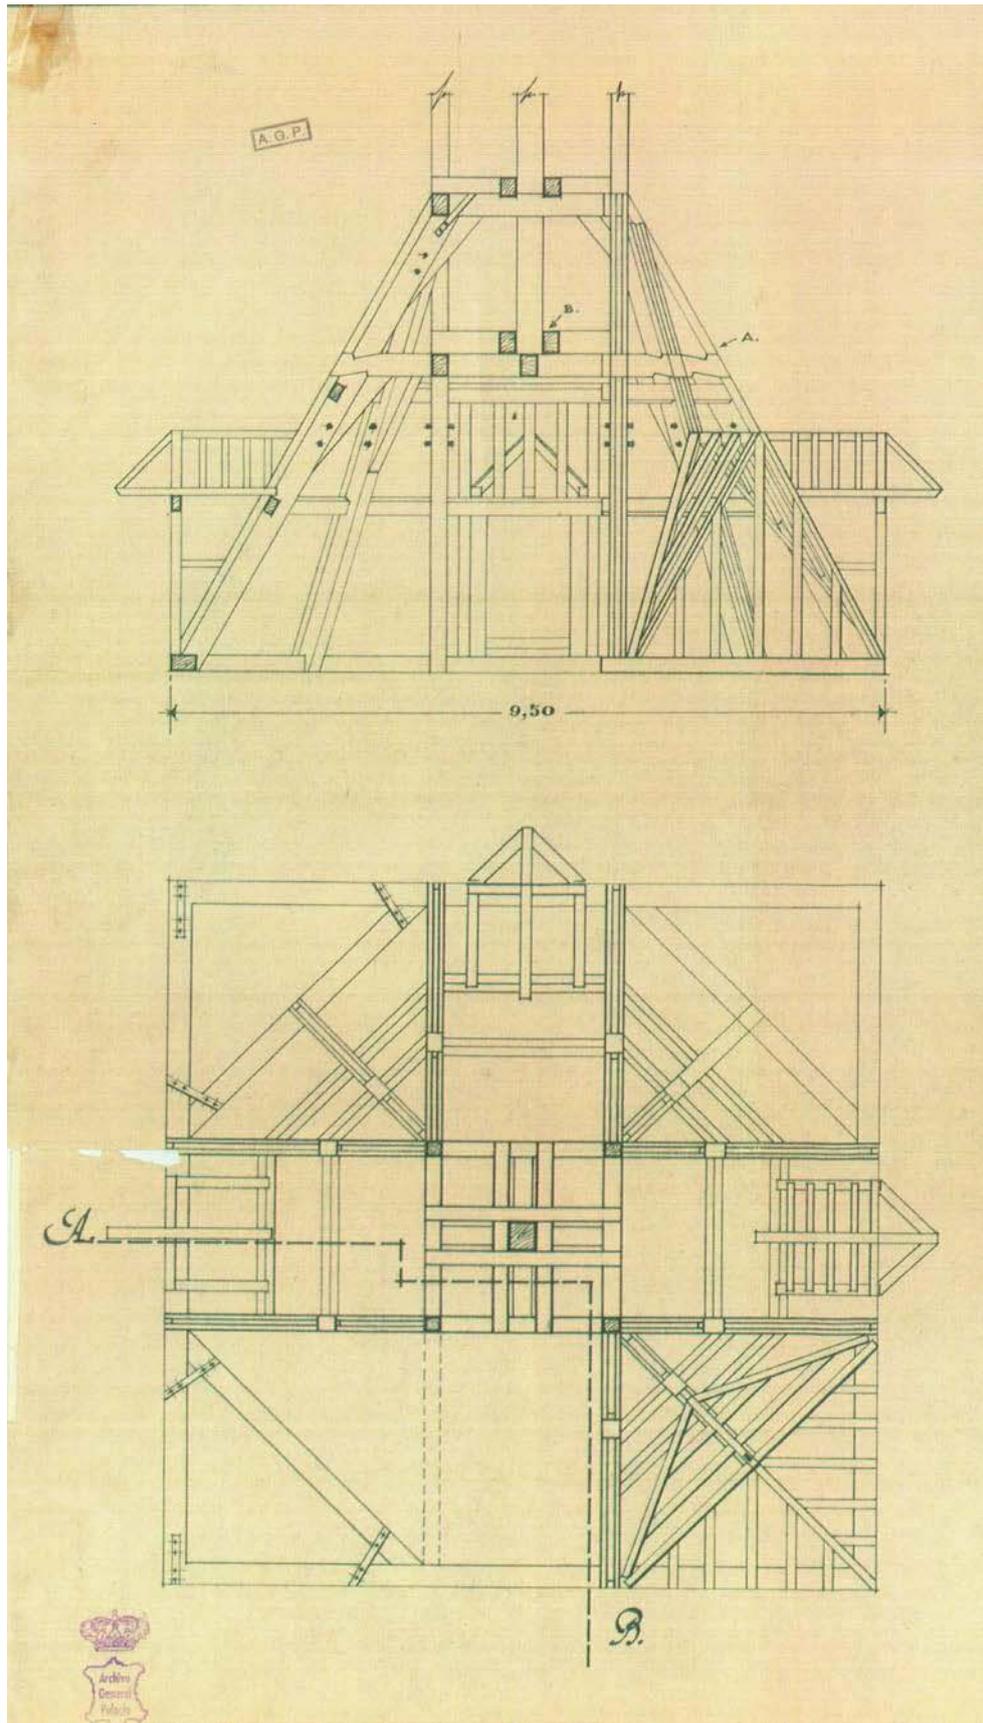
Planta y alzado de la armadura del cuerpo inferior del chapitel de la torre del Prior según el arquitecto Anselmo Arenillas. 1941 A.G.P. Planos 3588
